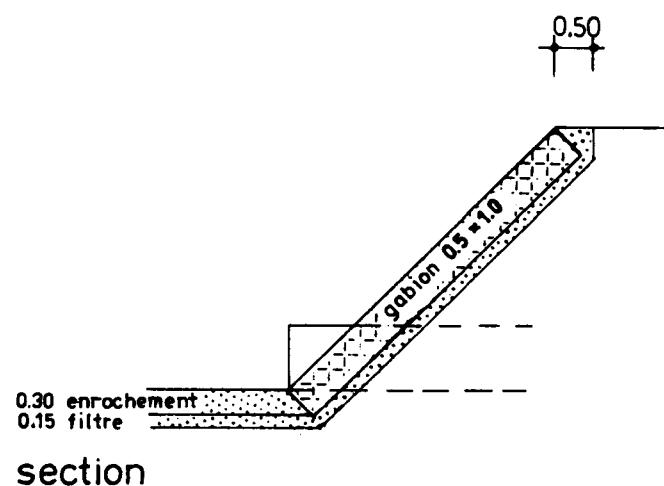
PLANS TYPE DE PROTECTION DES DALOTS SOUS CANAL (SUITE)
